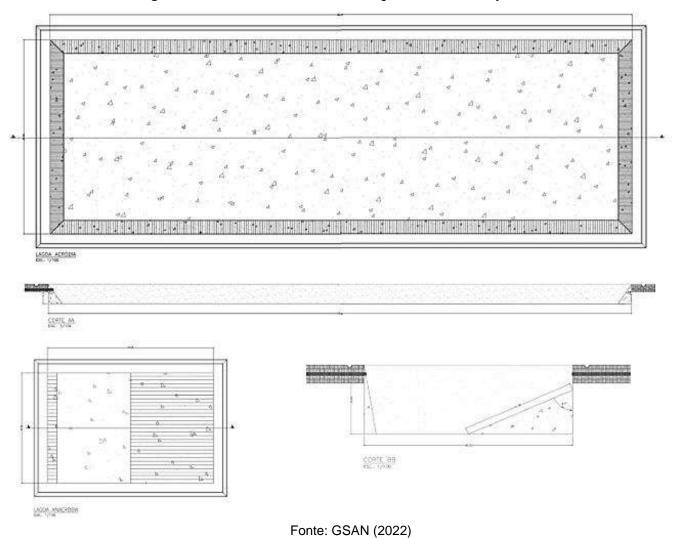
Cortes e detalhamento das lagoas de estabiblização
